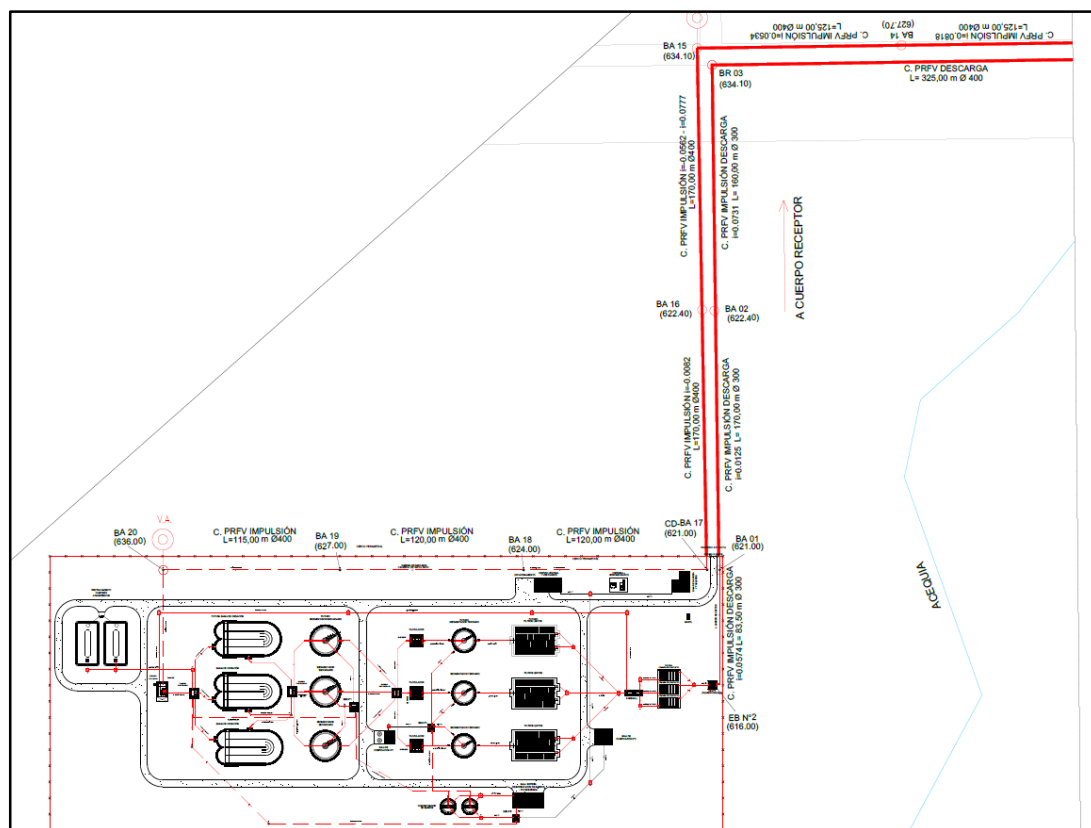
DETALLE DE CAÑERÍA DE ENTRADA A LA PLANTA.
